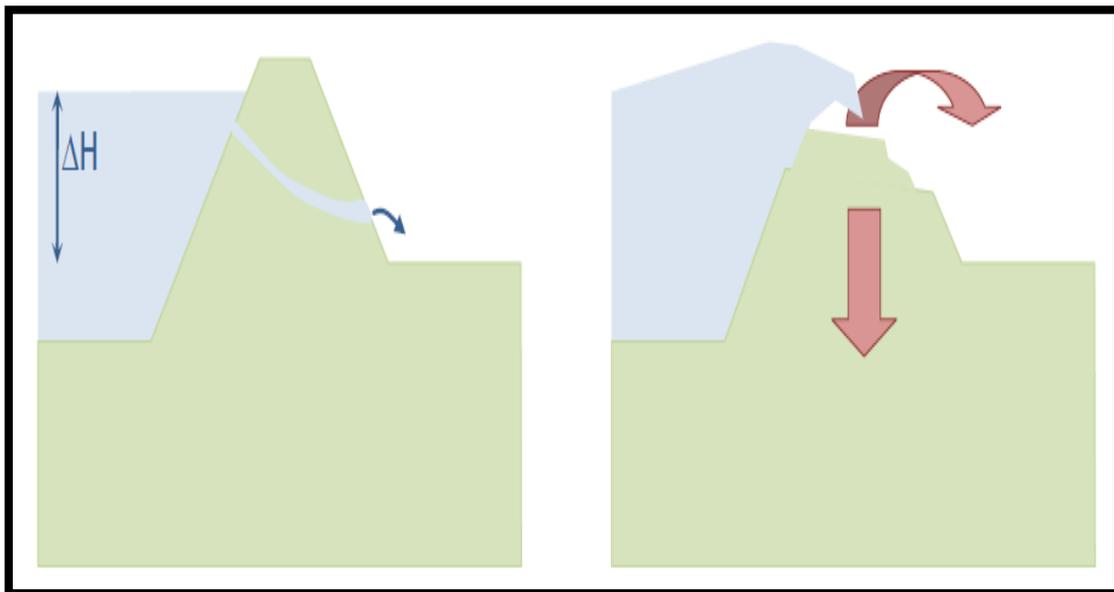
rupture du barrage par submersion à cause d'un renard (DESODT, 2016)
